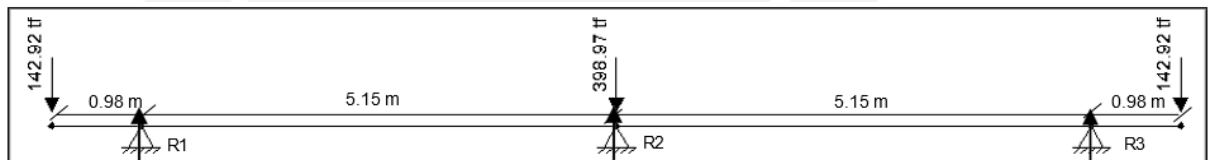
Modelo isostático de la zapata conectada para la primera verificación.
